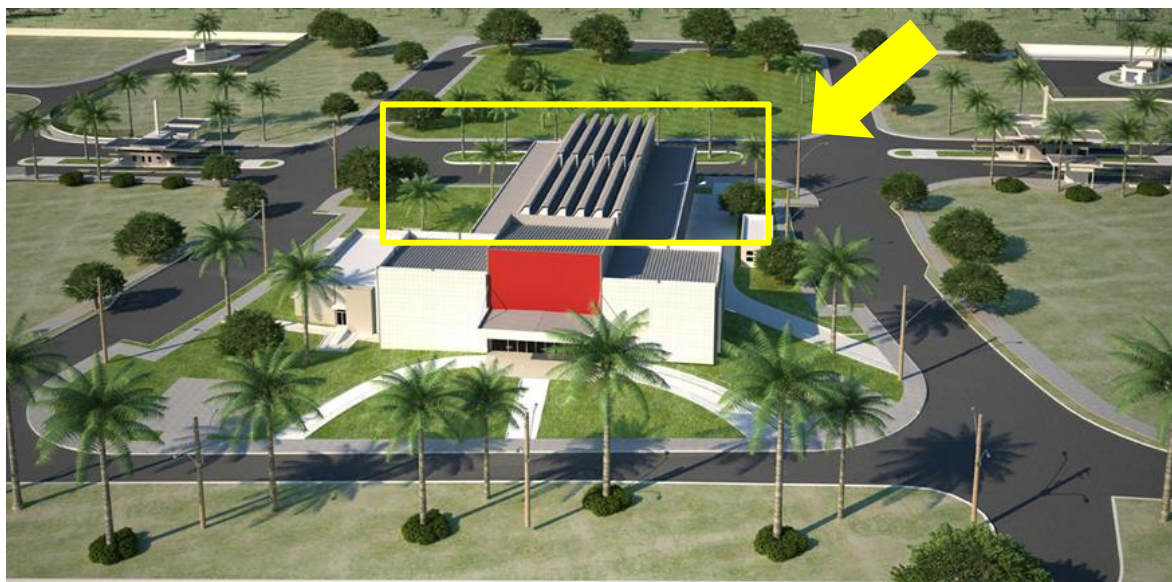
Instituto Inova com as instalações do EESC in a ser construída
